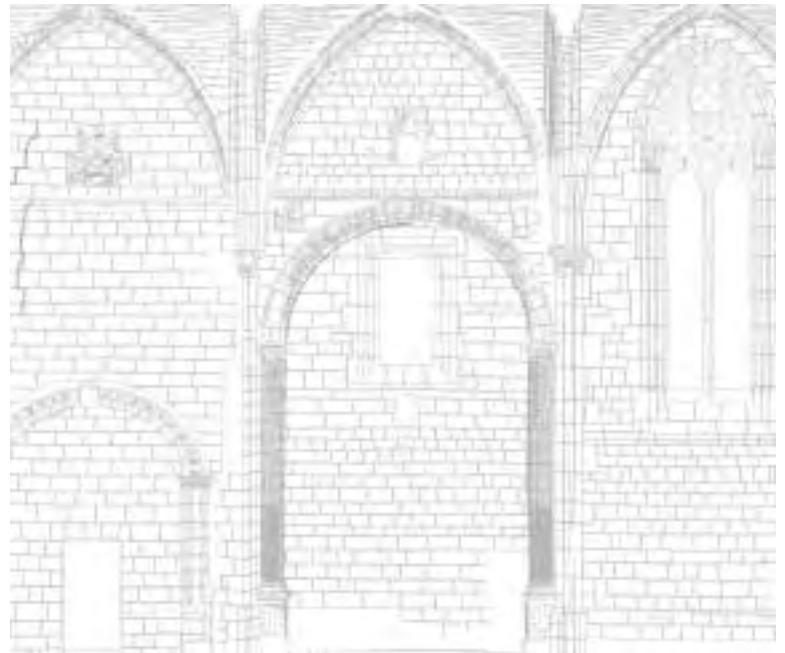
Alzado interior nave sur. Fisuras
